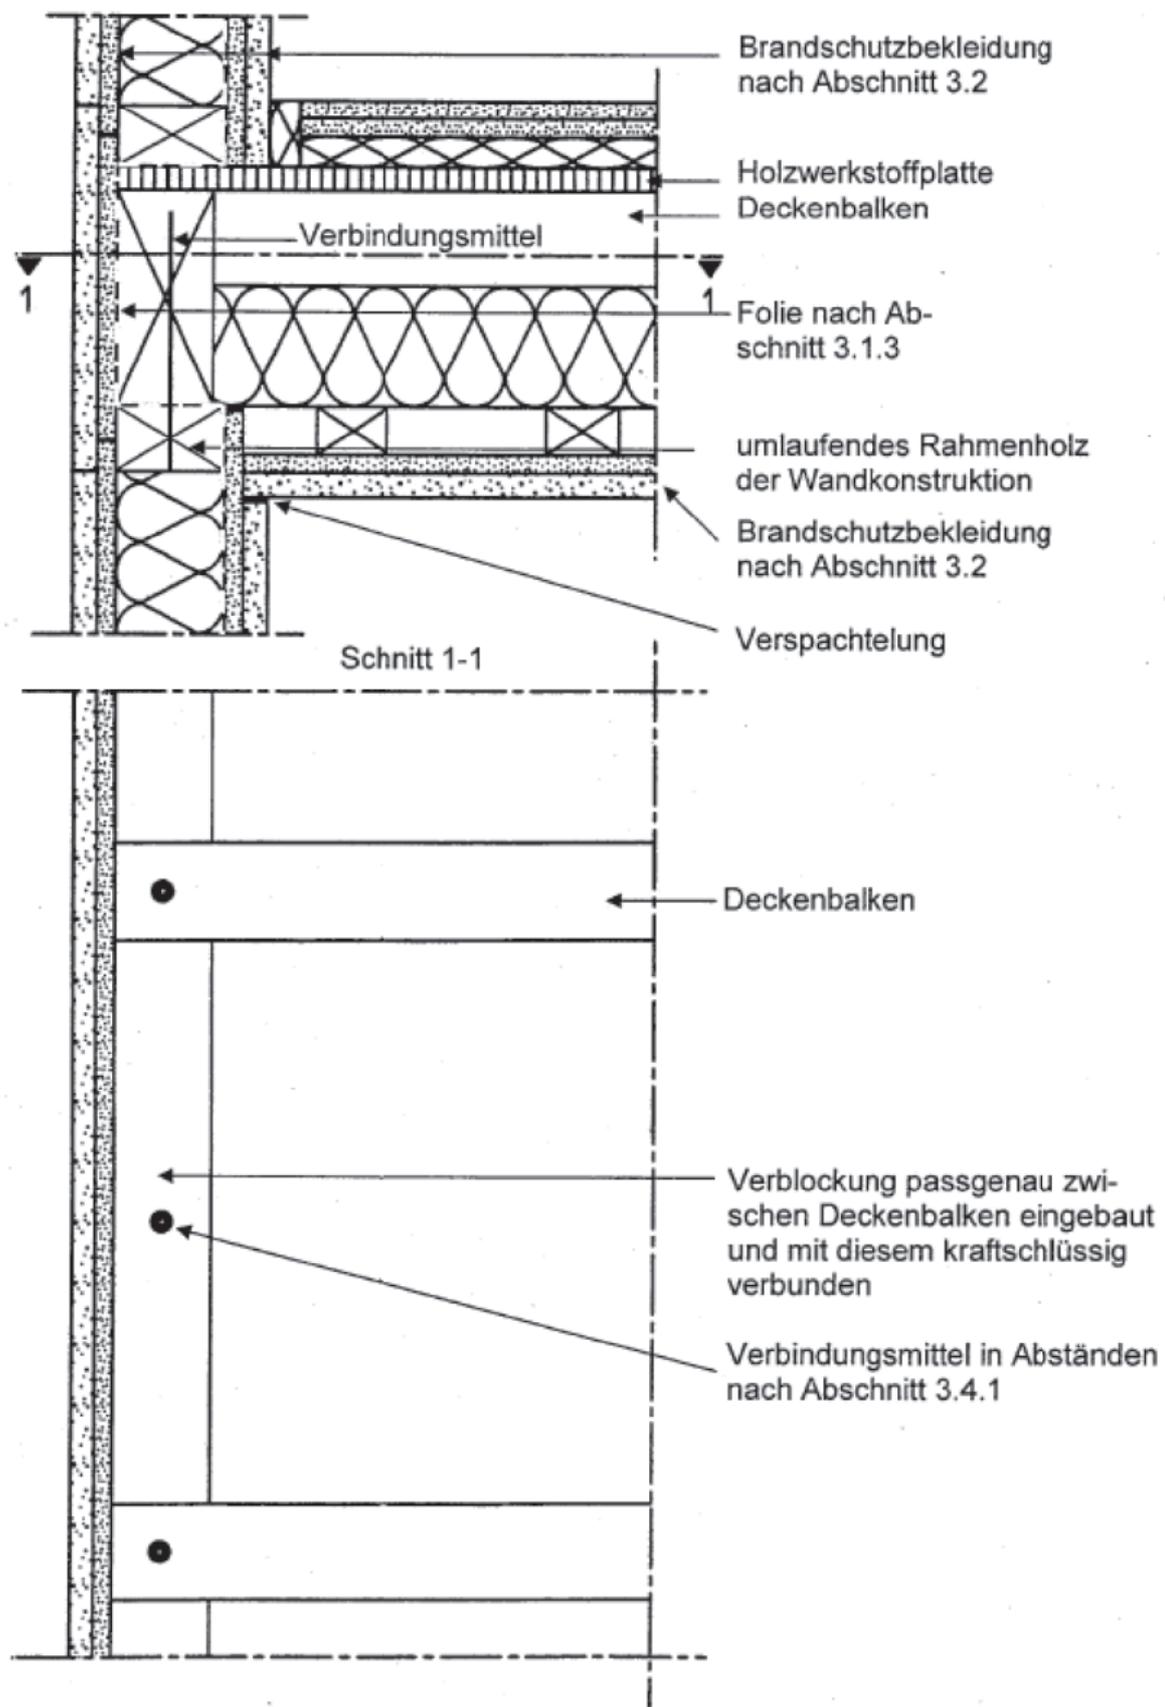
Anschluss Decke nach Abschn. 3.3.3 an tragende und raumabschließende Wand nach Abschn. 3.3.2 mit Brandschutzbekleidung nach Abschn. 3.2 (z. B. Treppenraumwand, Außenwand – Spannrichtung der Deckenbalken senkrecht zur Wand)
